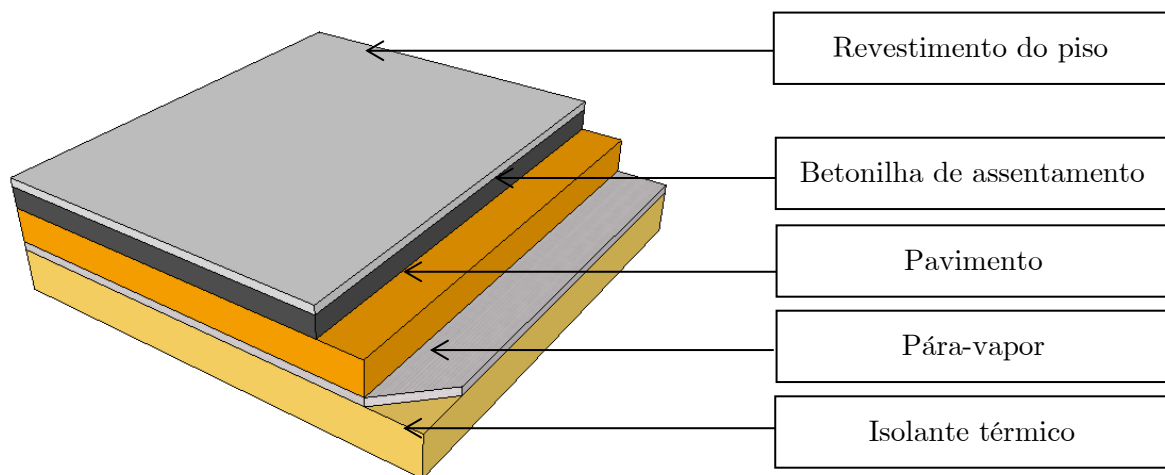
Sistema de isolamento térmico em pavimentos exteriores aplicado pela face inferior da laje de pavimento
